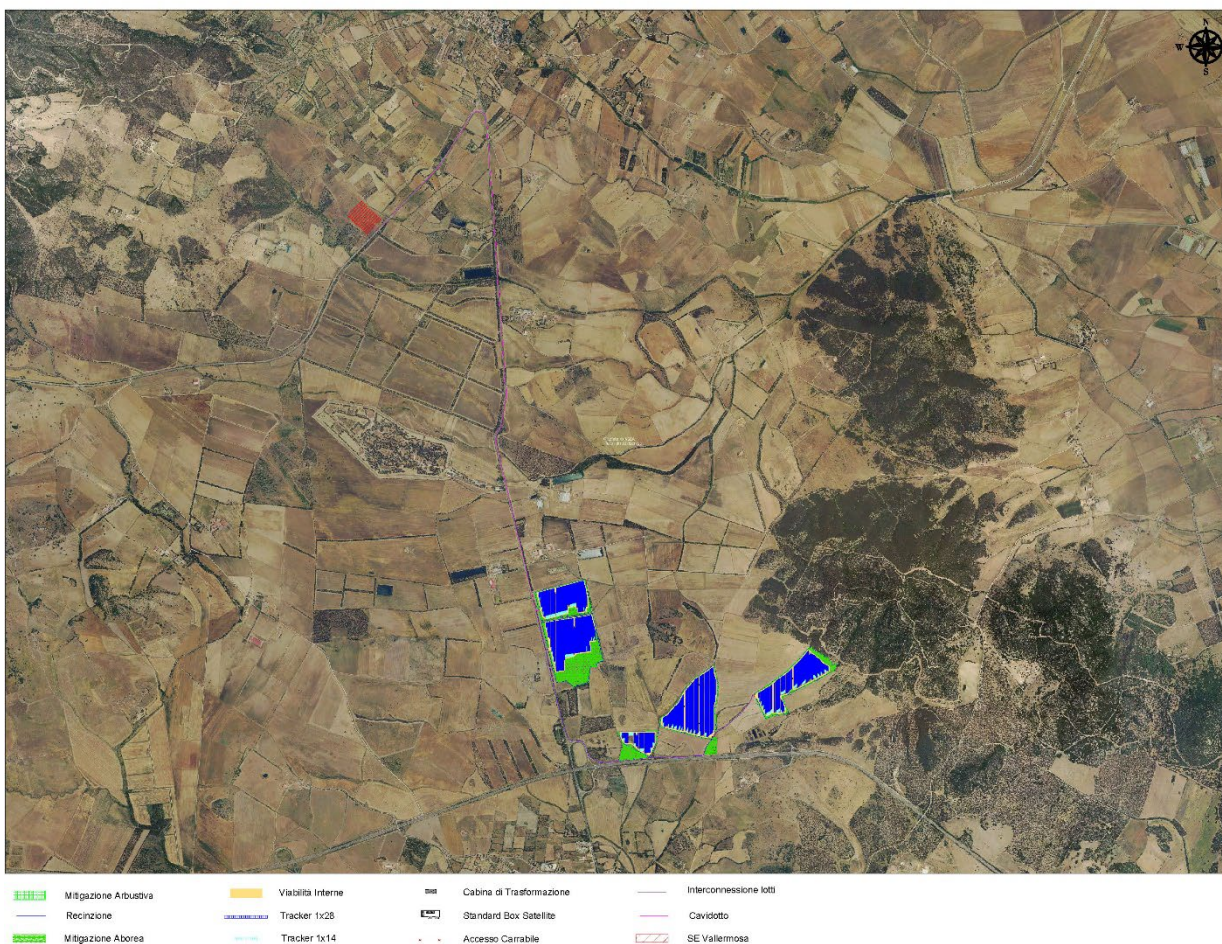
Ortofoto dell’area d’impianto con pannelli ricadente nel territorio di Siliqua (SU) località “Giba”
